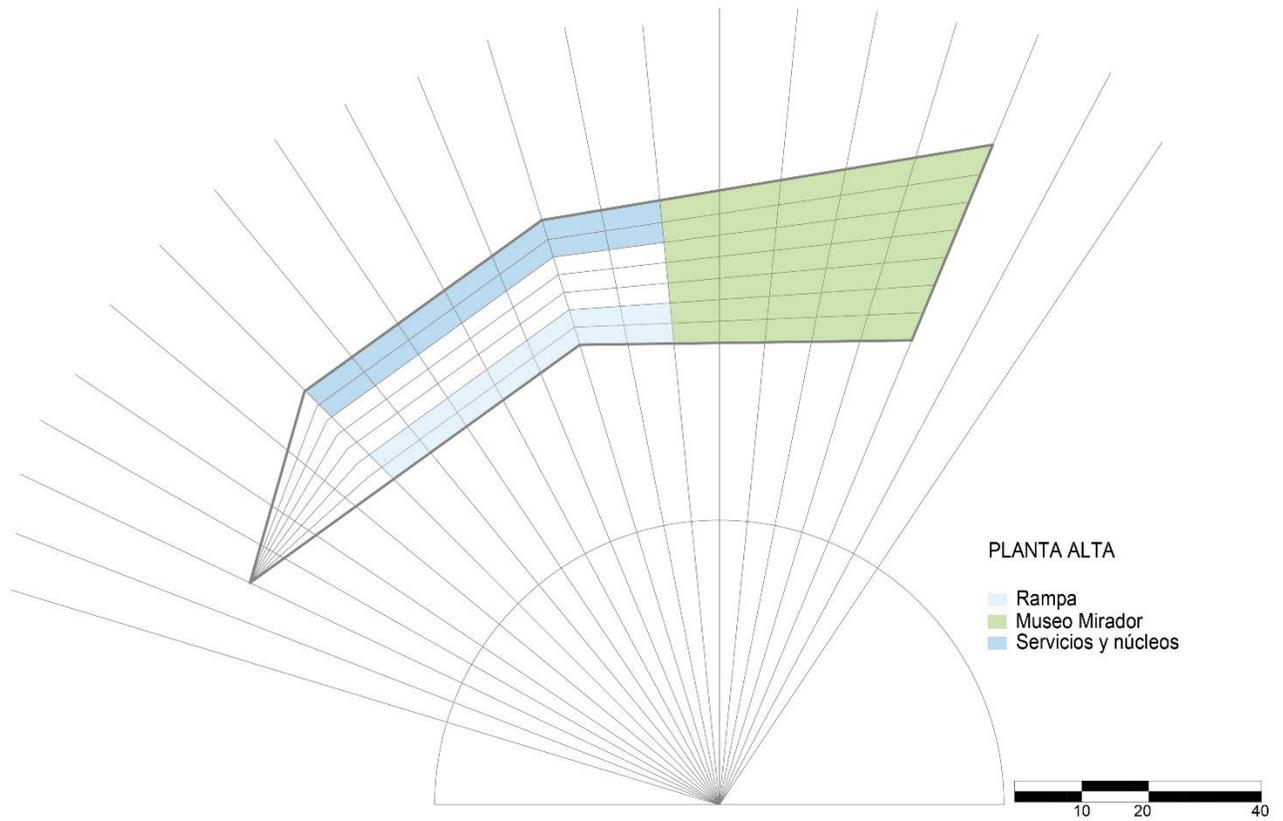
Zonificación de Planta Alta. Elaboración propia.
